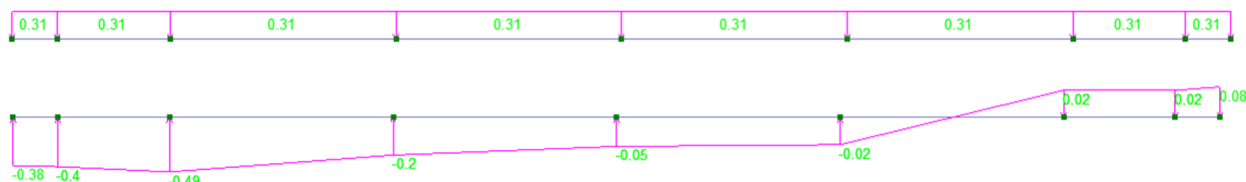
Схема приложения нагрузки на балку: верх – нагрузка от собственного веса кровли, низ – ветровая нагрузка
